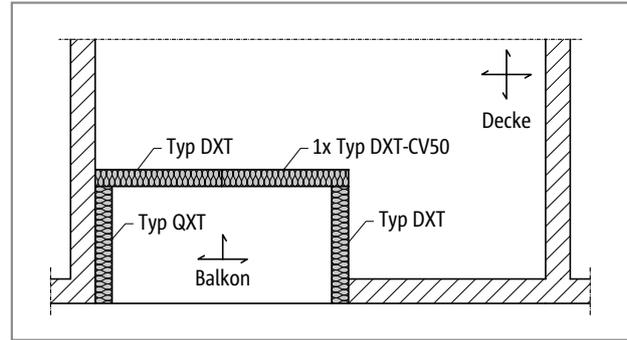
Schöck Isokorb® Typ DXT, QXT: Decke kreuzweise gespannt; Einspannwirkung Schöck Isokorb® ist jedoch nur einachsial vorhanden
